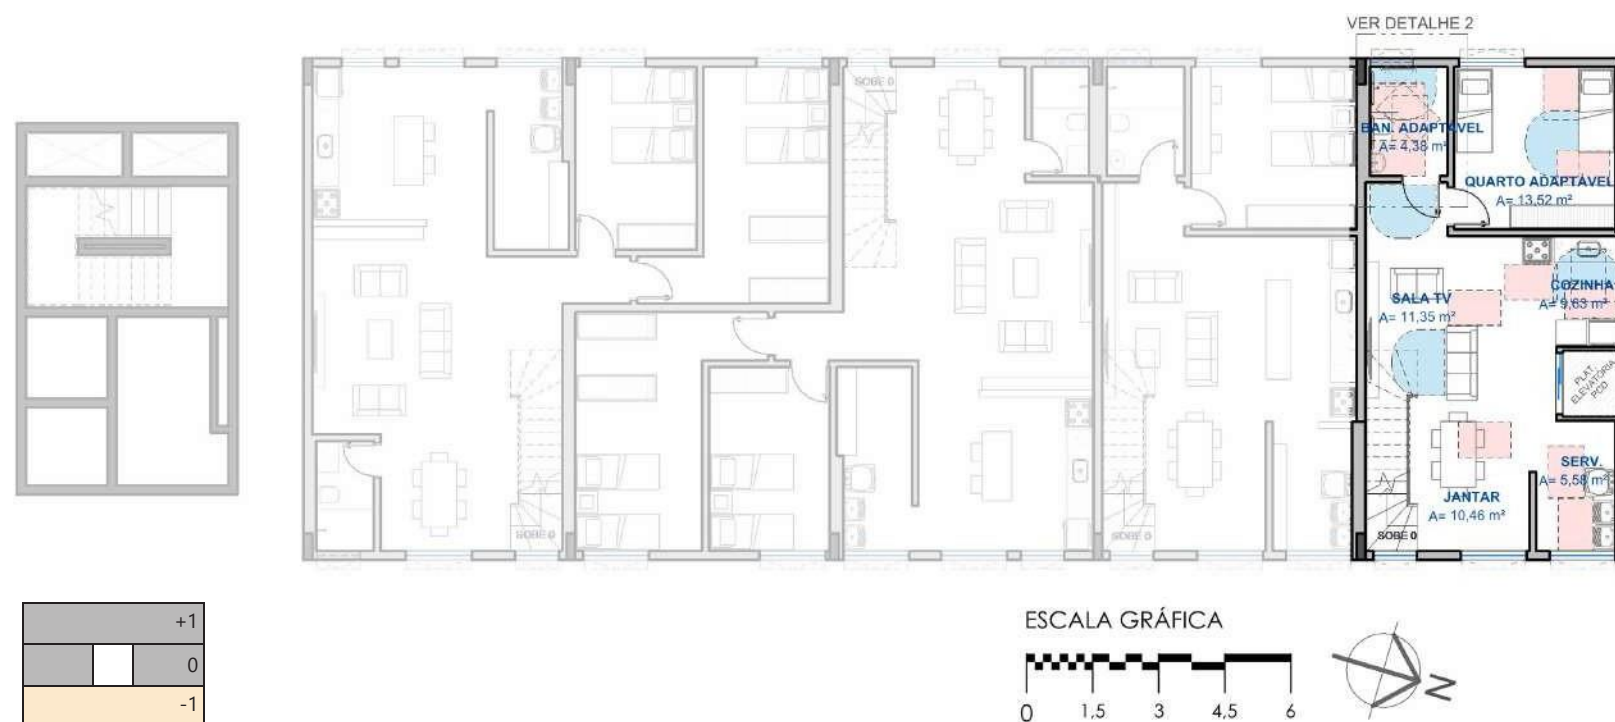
Planta Baixa Nível -1 TA - Adaptável
